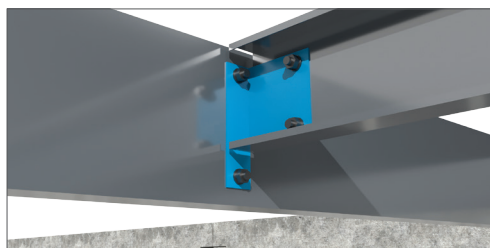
Szczegóły połączenia wymianów poziomych do elementu betonowego, za pomocą kątownika przyspawanego do płyty stalowej w elemencie betonowym
